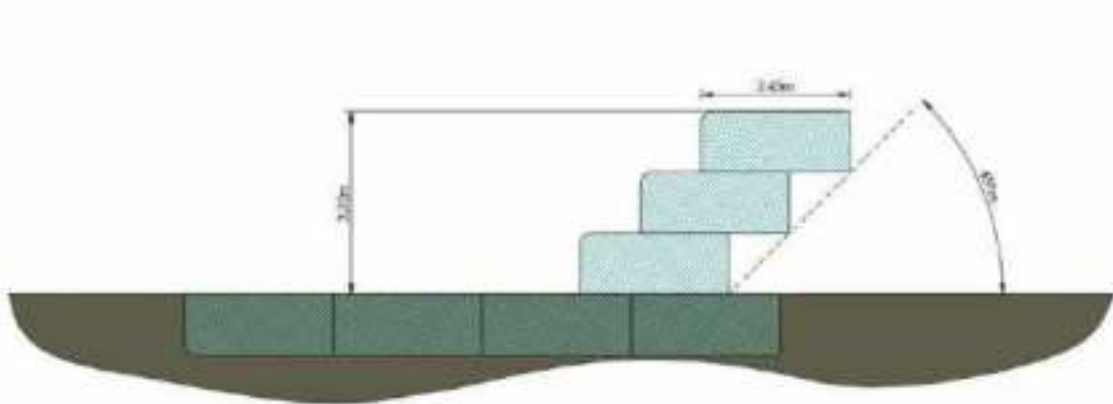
Sección transversal, ángulo de inclinación de la estructura.
